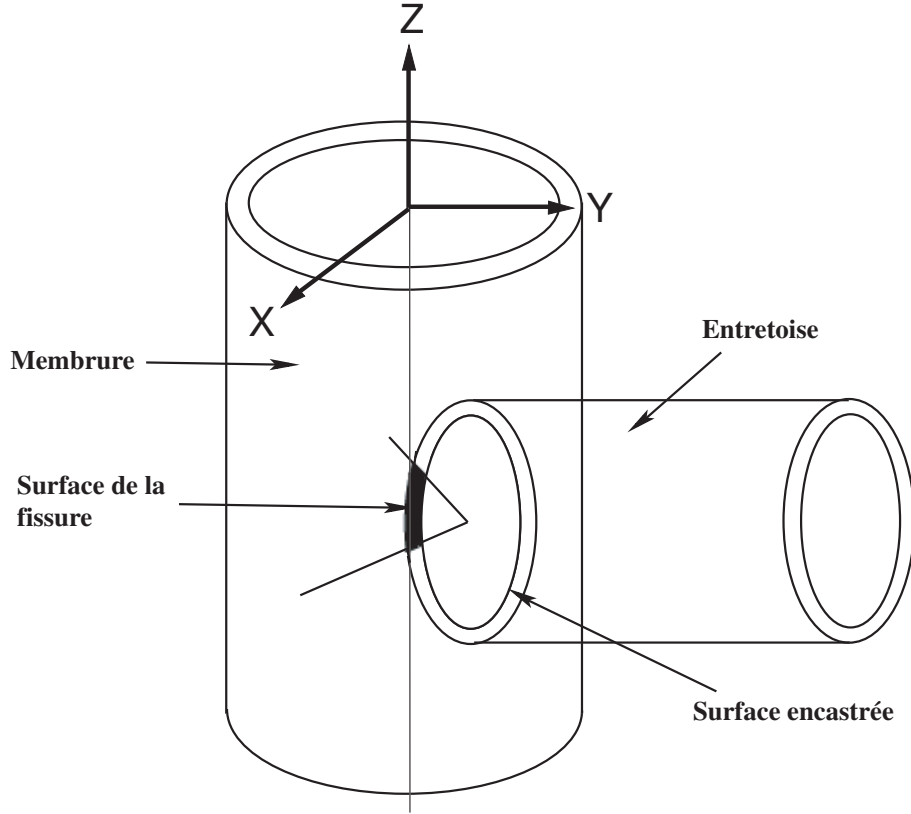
Schéma d'un joint d'une structure en T fissurée.
